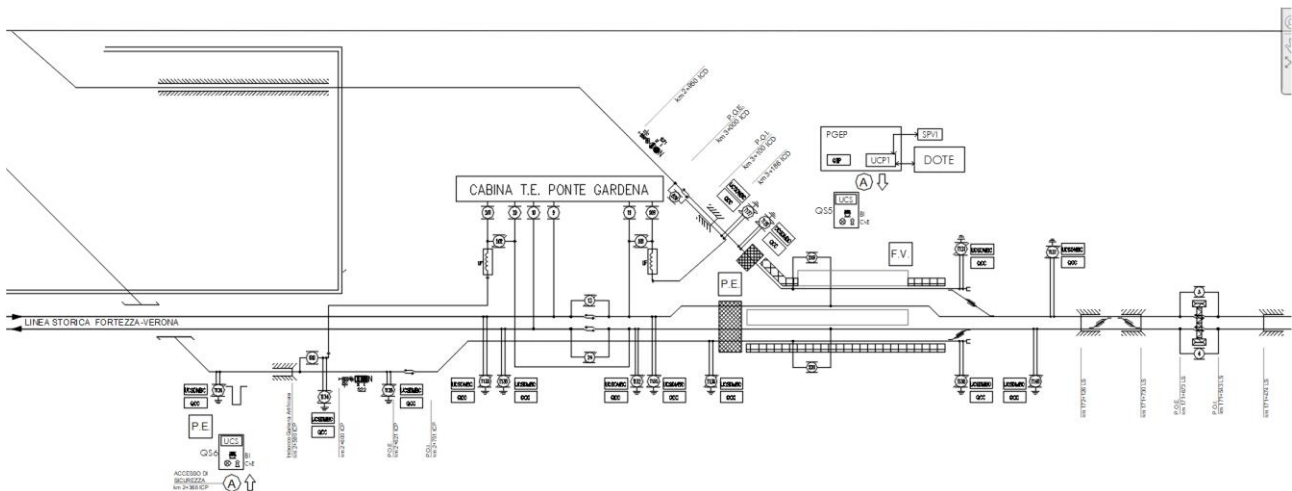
Stralcio schema TE stazione di Ponte Gardena
